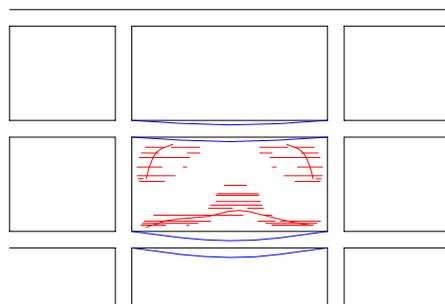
Fissuras causadas por uma flecha maior na viga inferior
